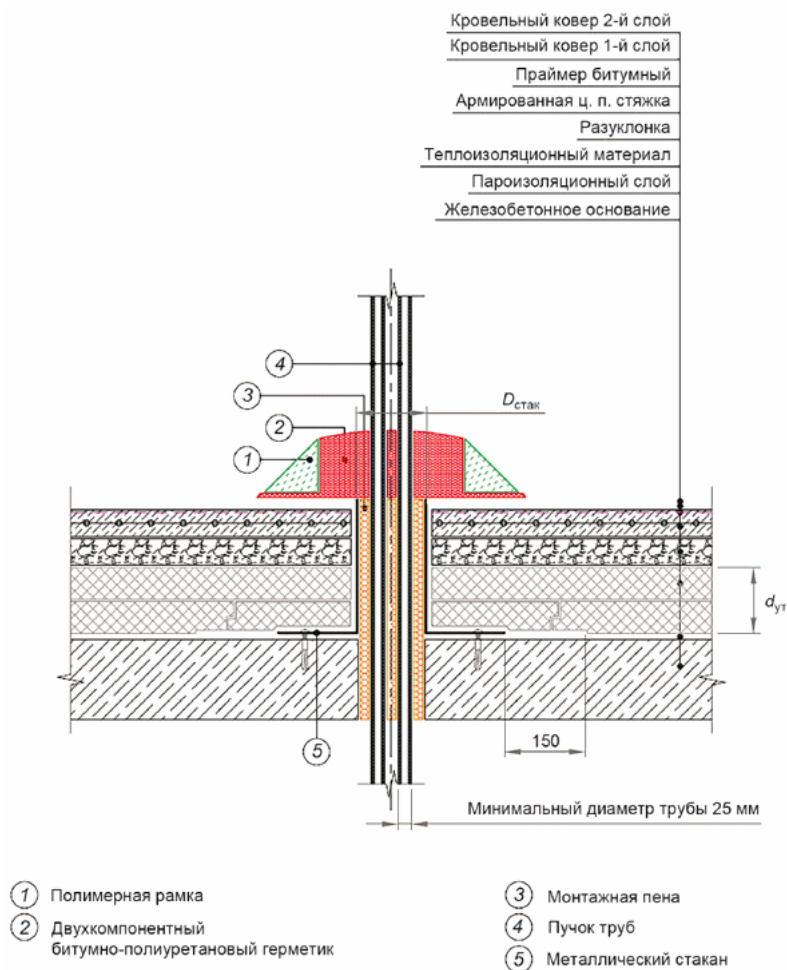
Схема пропуска электрического кабеля через совмещенное кровельное покрытие
